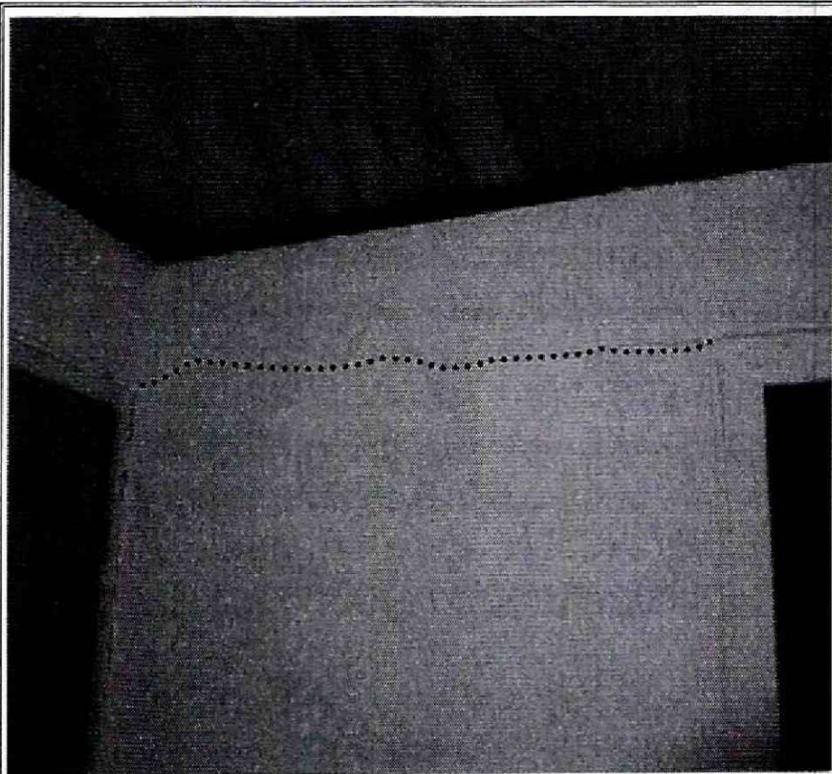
Fisura muro de cerramiento perimetral primer nivel vivienda emplazada en el predio de la Calle 51 D Sur No. 4 – 01 Este
